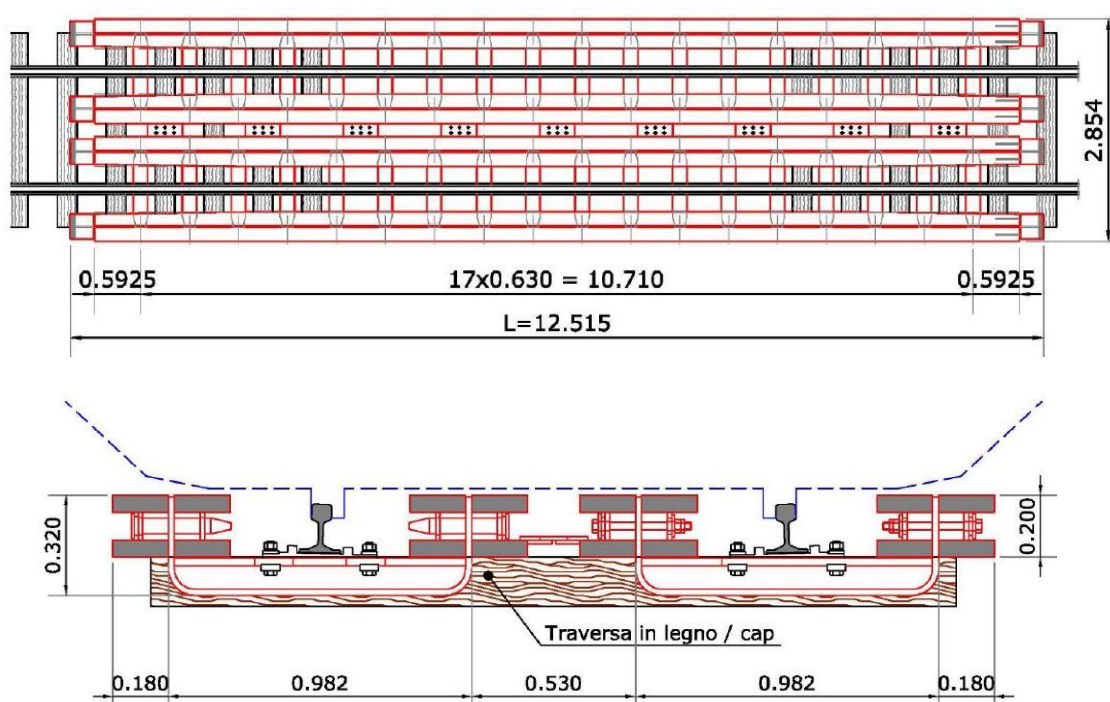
Sistema di sostegno provvisorio “Ponte Essen” – pianta e sezione trasversale (MdP P.II sez.2)
